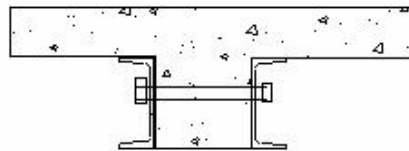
Consolidación de vigas mediante estructura metálica
